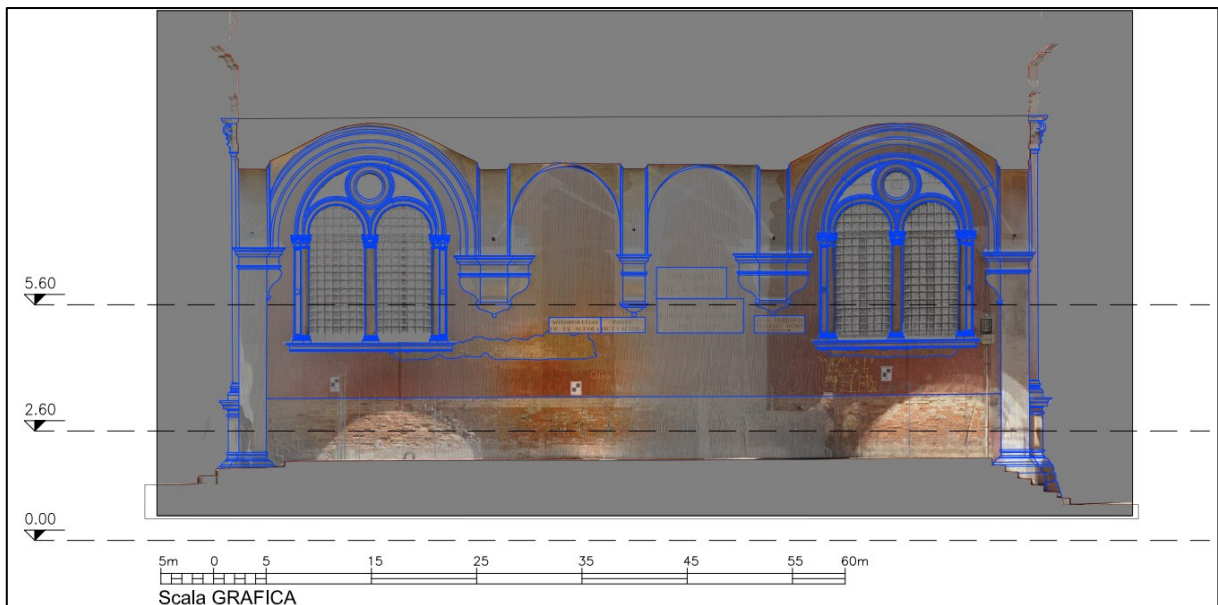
Sezione 2 – Sezione verticale con sovrapposizione dell'orto-proiezione del modello tridimensionale
